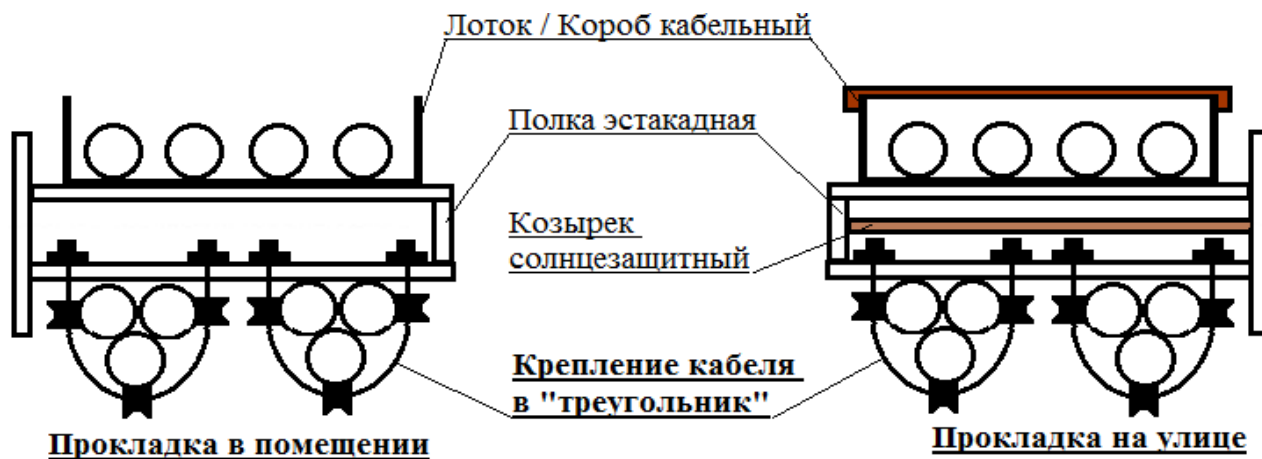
Прокладка силовых кабелей в помещении и на улице
